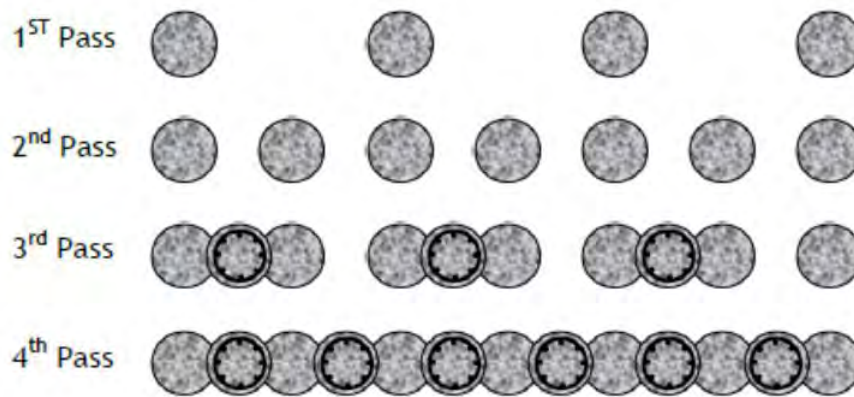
Fases de construcción de pantallas de pilotes secantes. (Fuente: Wharmby, 2010)
